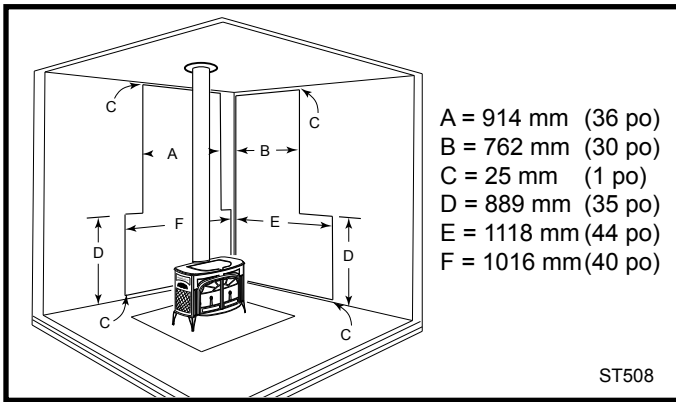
Installation parallèle, connecteur vertical de cheminée, deux protecteurs muraux. Espaces libres réduits pour les murs arrière et latéraux. Les protecteurs muraux peuvent se rejoindre dans un coin, au besoin. La protection pour le connecteur est centrée à l'arrière du connecteur.
